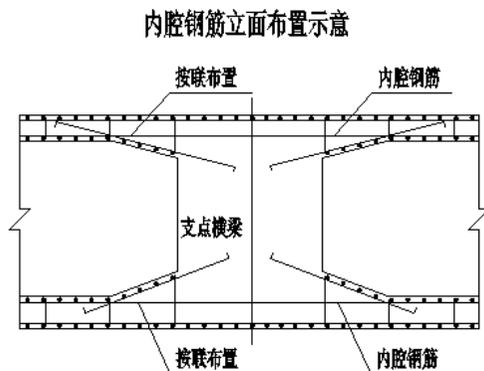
箱梁钢筋-内腔钢筋布置方式-按联布置
